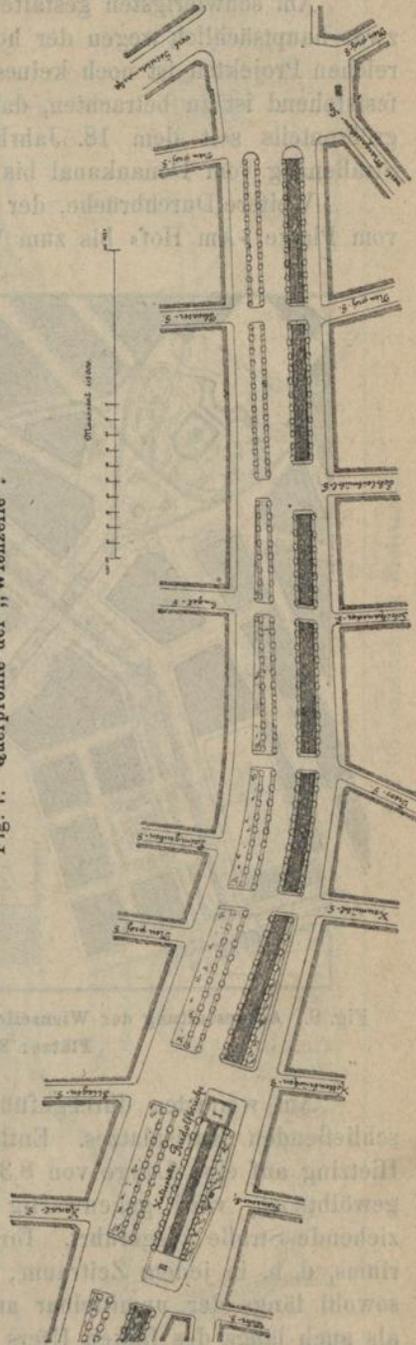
Lageplan eines Teiles der „Wienzeile“.
